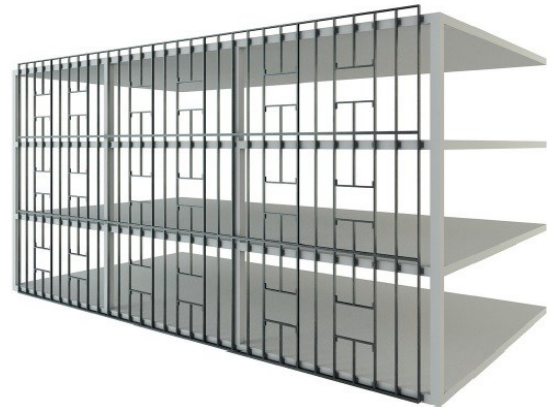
, e a tipologia de painéis cortina com a instalação de todo o sistema de vedação externamente ao plano da estrutura da edificação (Figura 6).
